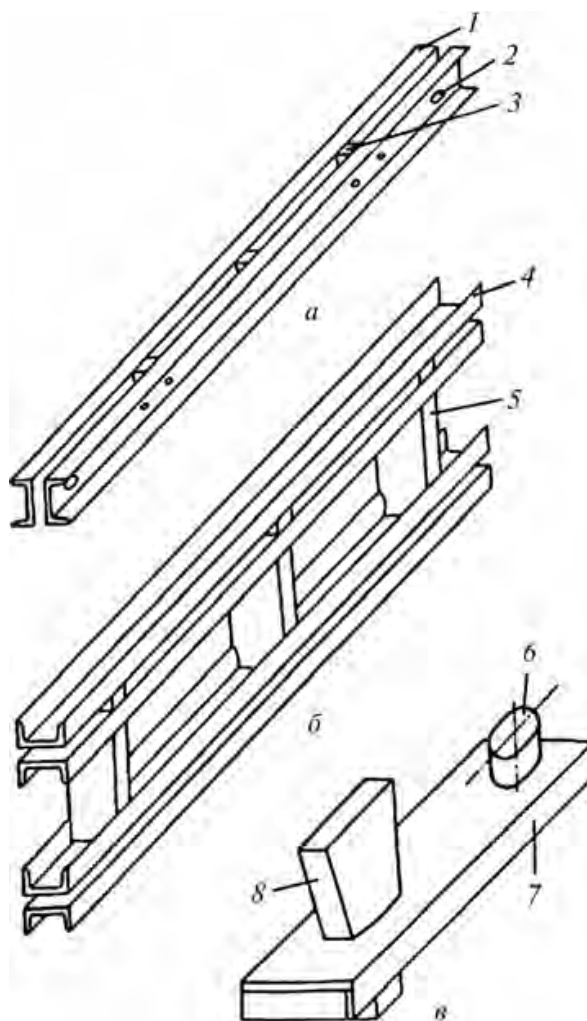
Поддерживающие элементы опалубки: а — схватка; б — балка; в — чека для соединения; 1 — швеллер; 2 — овальное отверстие для пропуска клина при соединении чек под углом; 3 — соединение швеллеров; 4 — элемент схватки; 5 — пластины соединения схваток; 6 — опорный палец; 7 — пластина; 8 — клин
